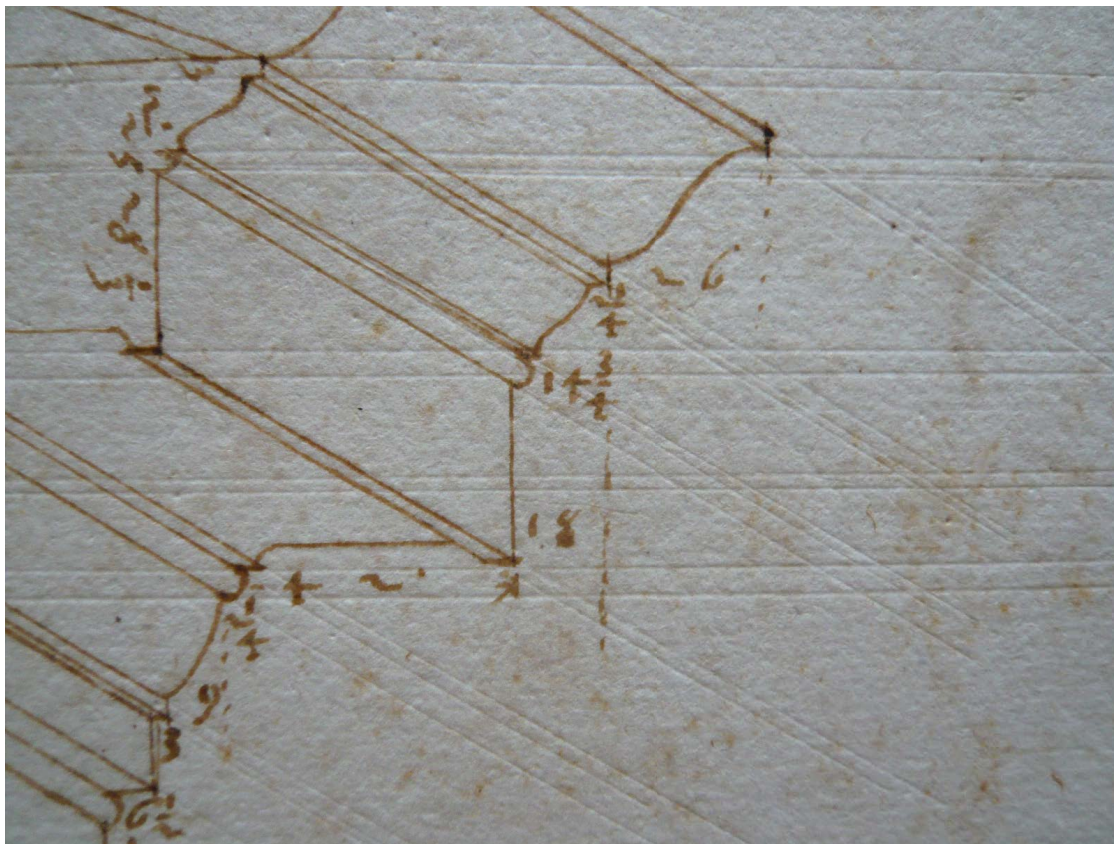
Portico di Ottavia, Detail oben links. Palladio MCV-D26r (Foto der Autorin).
